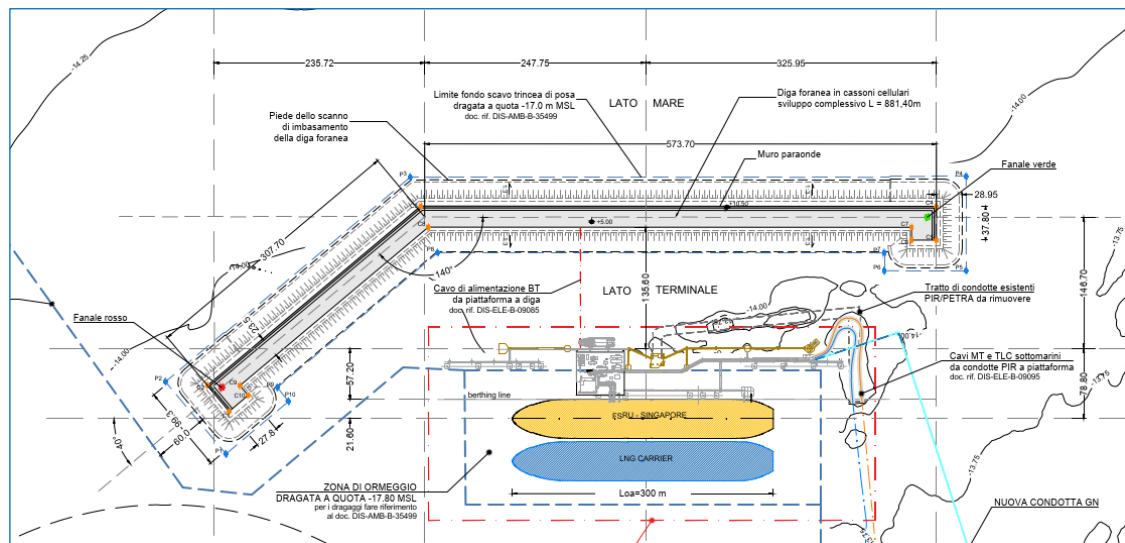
Vista planimetrica diga frangi flutti ottimizzata
